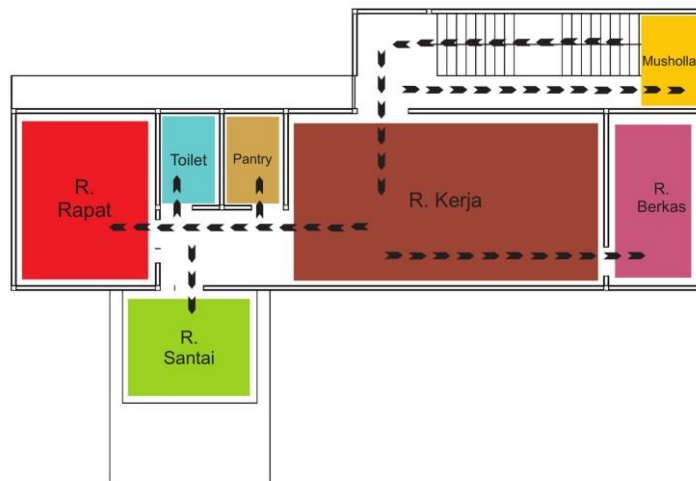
Zoning dan sirkulasi alternatif 1 lantai 1
